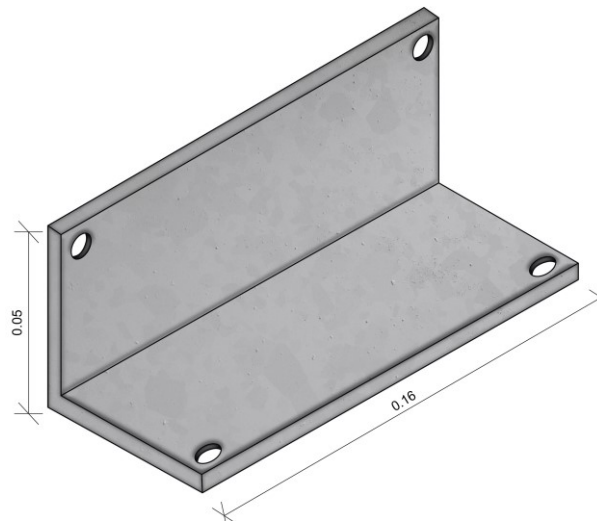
Detalle de anclaje A1, de columna o muro estructural a perfil tipo "U"
